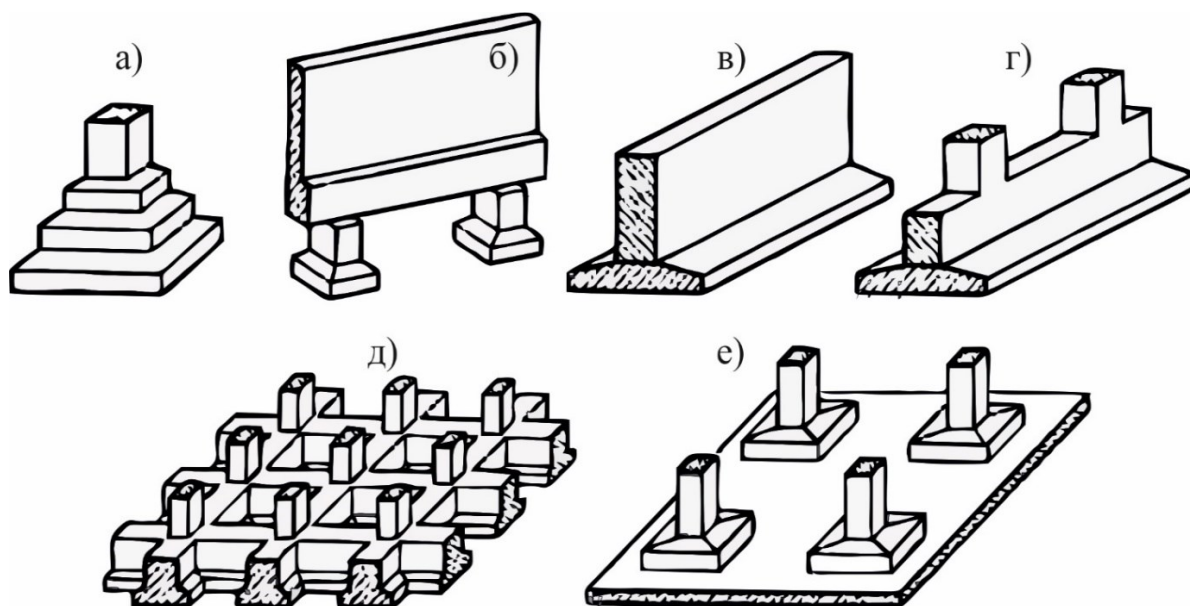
Основные типы фундаментов мелкого заложения:
